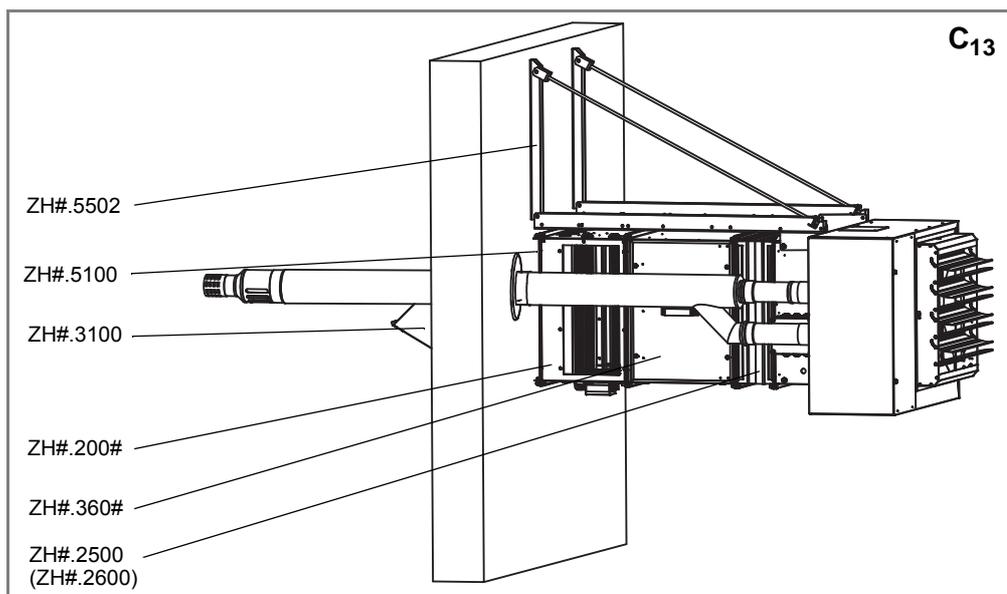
Wandmontage des Mischluftgerätes mit coaxialer Abgasleitung
